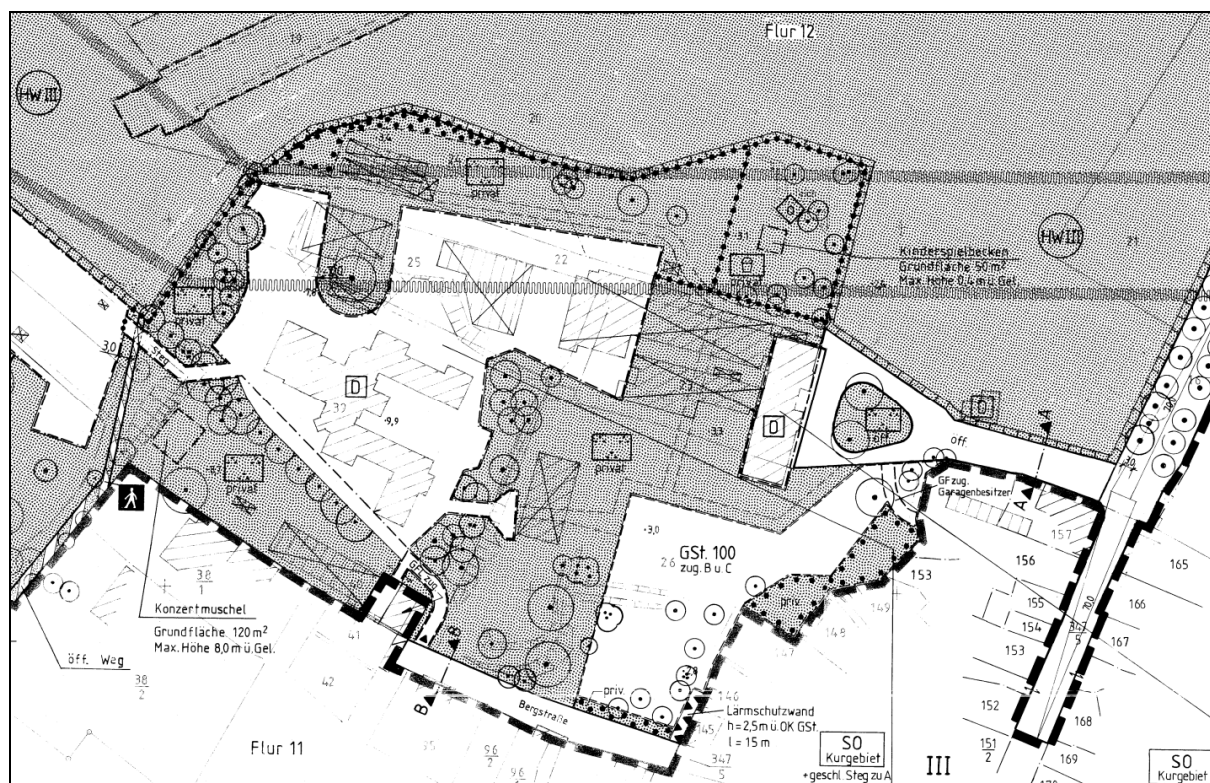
Ausschnitt des alten Planes im Bereich der geplanten Änderung
